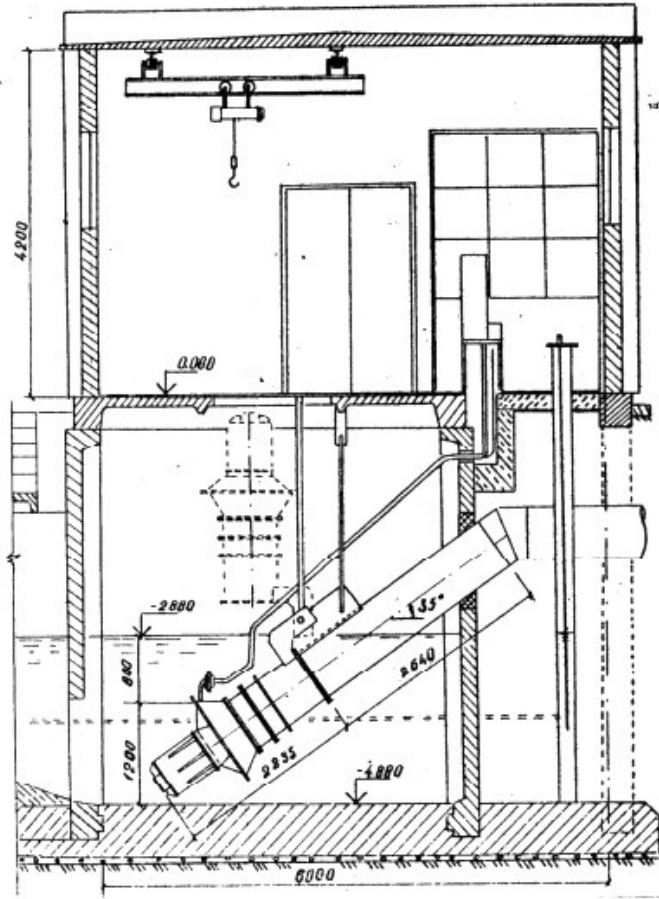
Типовий поперечний розріз будівлі насосної станції із зануреним насосом 1ОПВ 2500-4,2
